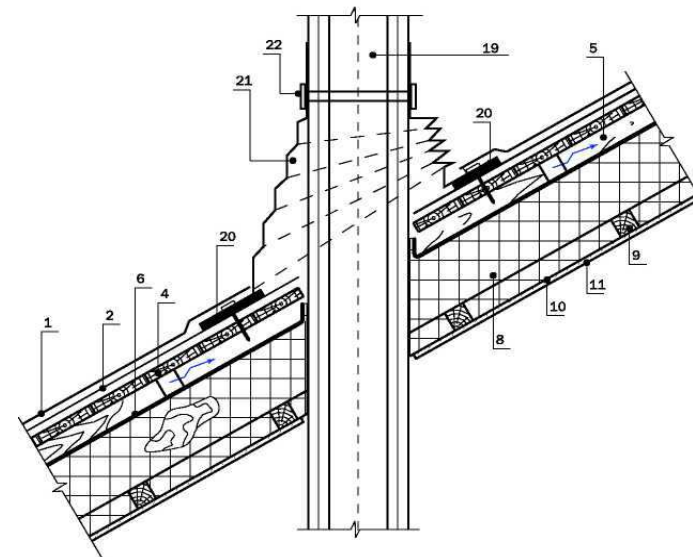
Примыкание кровли к дымовой металлической трубе
